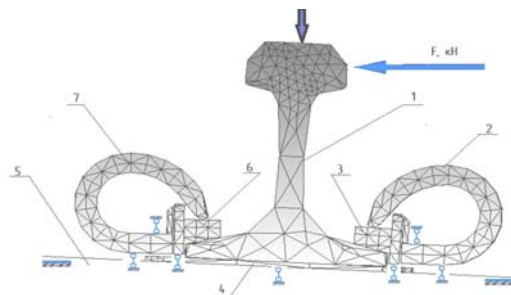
Розрахункова схема вузла рейкового скріплення типу КПП-5:
